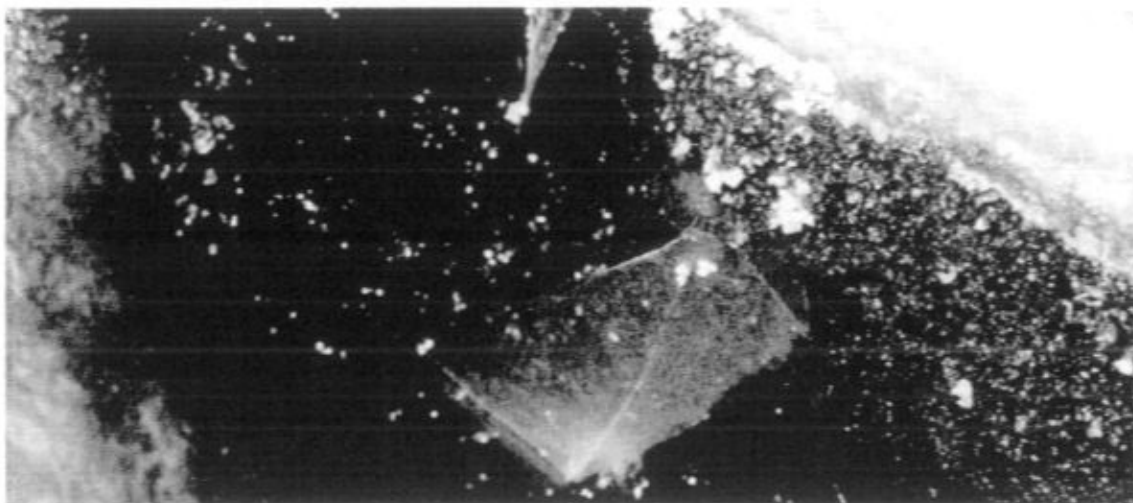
Particolare della macchia rappresa a tetto con la presenza di una ragnatela.
